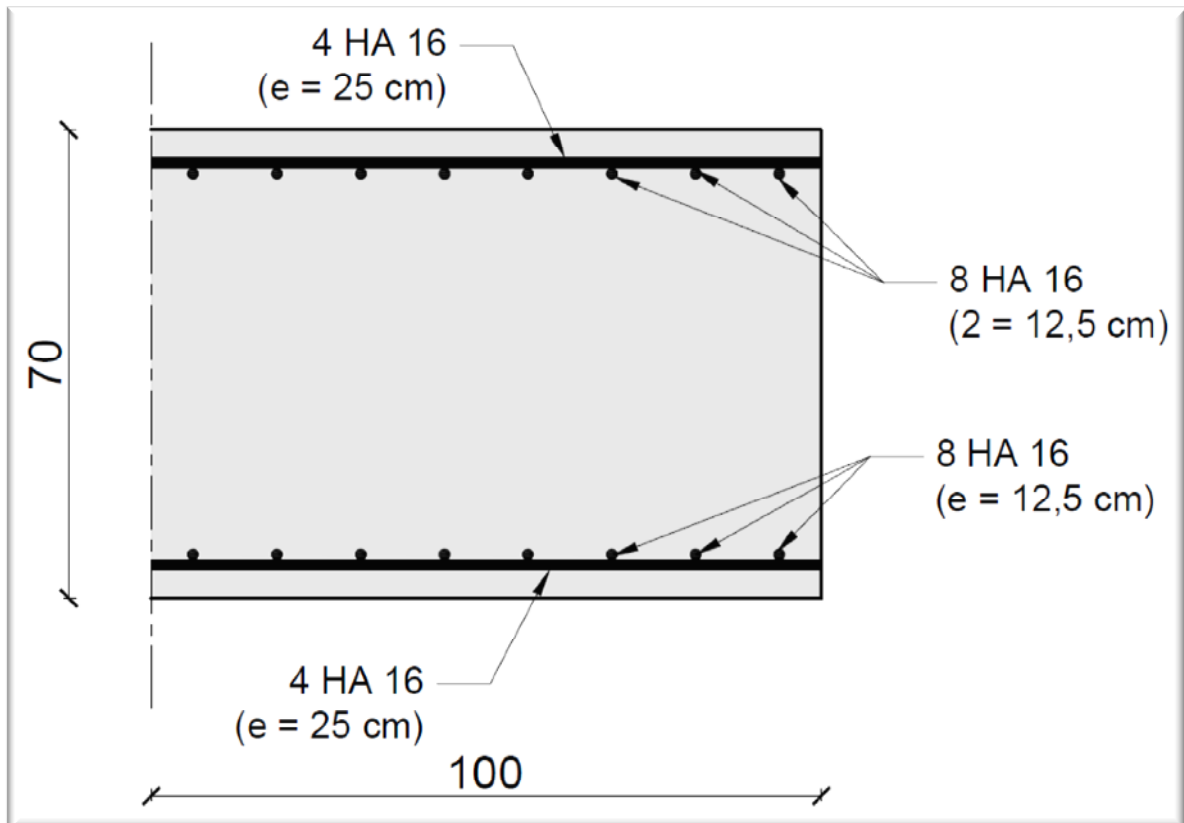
Schéma de ferrailage de piedroit intermédiaire.
